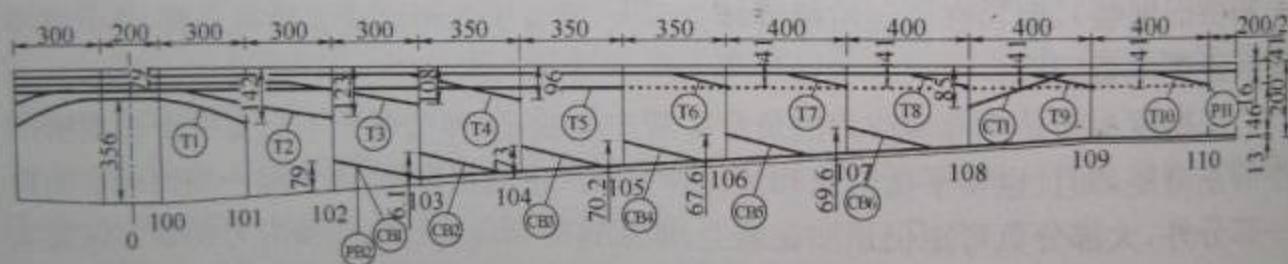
某桥中跨预应力束布置图(尺寸单位:cm)
